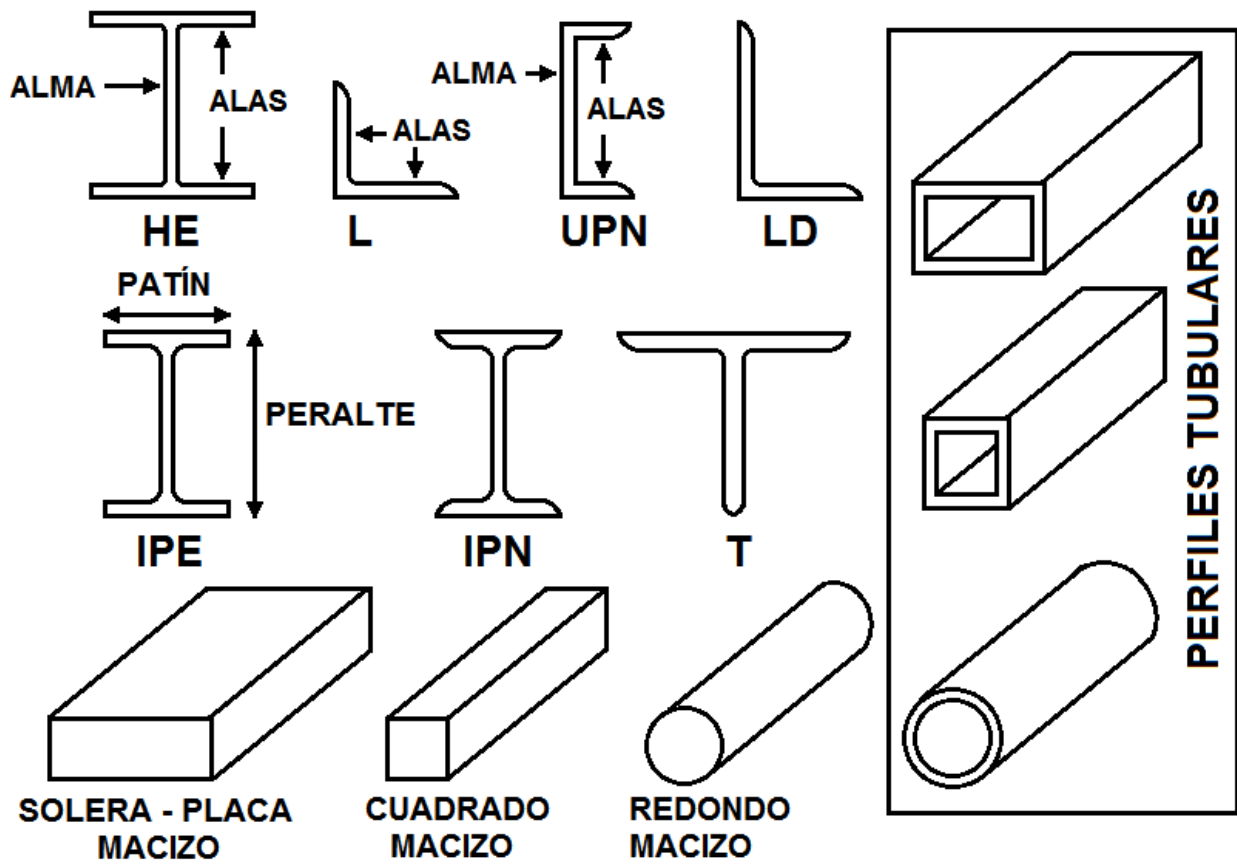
Perfiles usados en la construcción de estructuras metálicas
